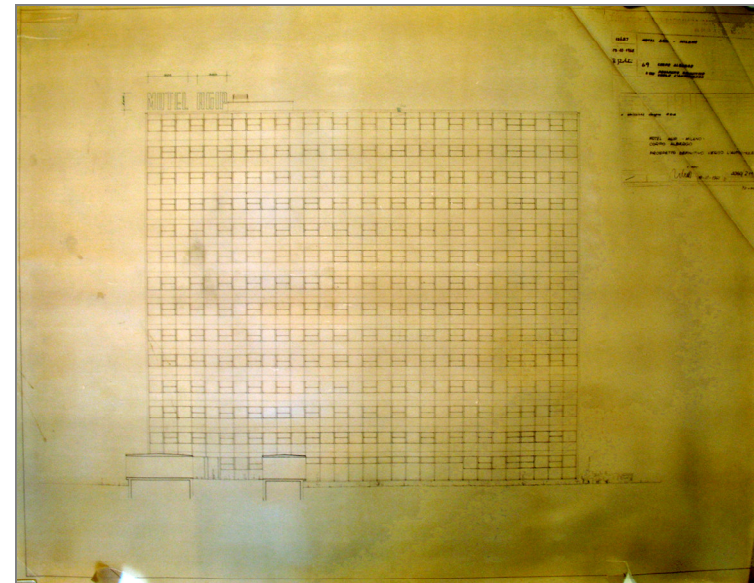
prospetto verso l'autostrada (fonte CSAC – tav. 69, archivio n. 181-2)
